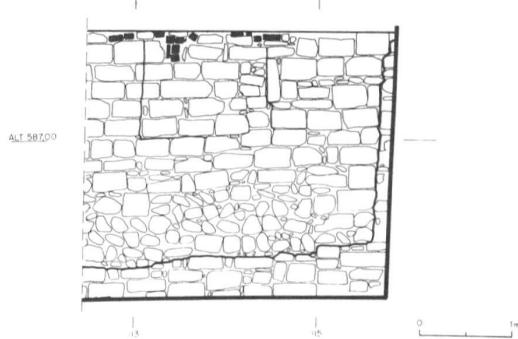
Rue du Pont-Suspendu 74–75. Relevé au pierre à pierre de l'extrémité nord du mur occidental du bâtiment n° 235 avec la niche d'encastrement du battant de la porte de la façade nord.
